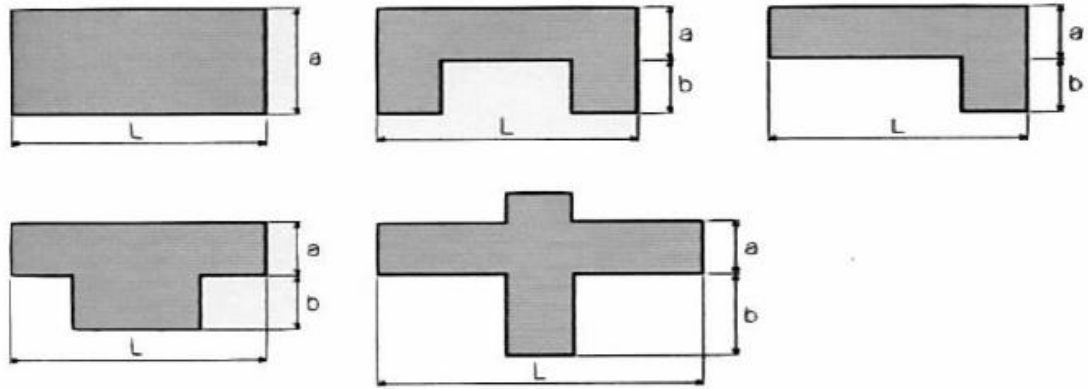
Configuración de planta de la estructura (Benedetti & Petrini, 1984)
